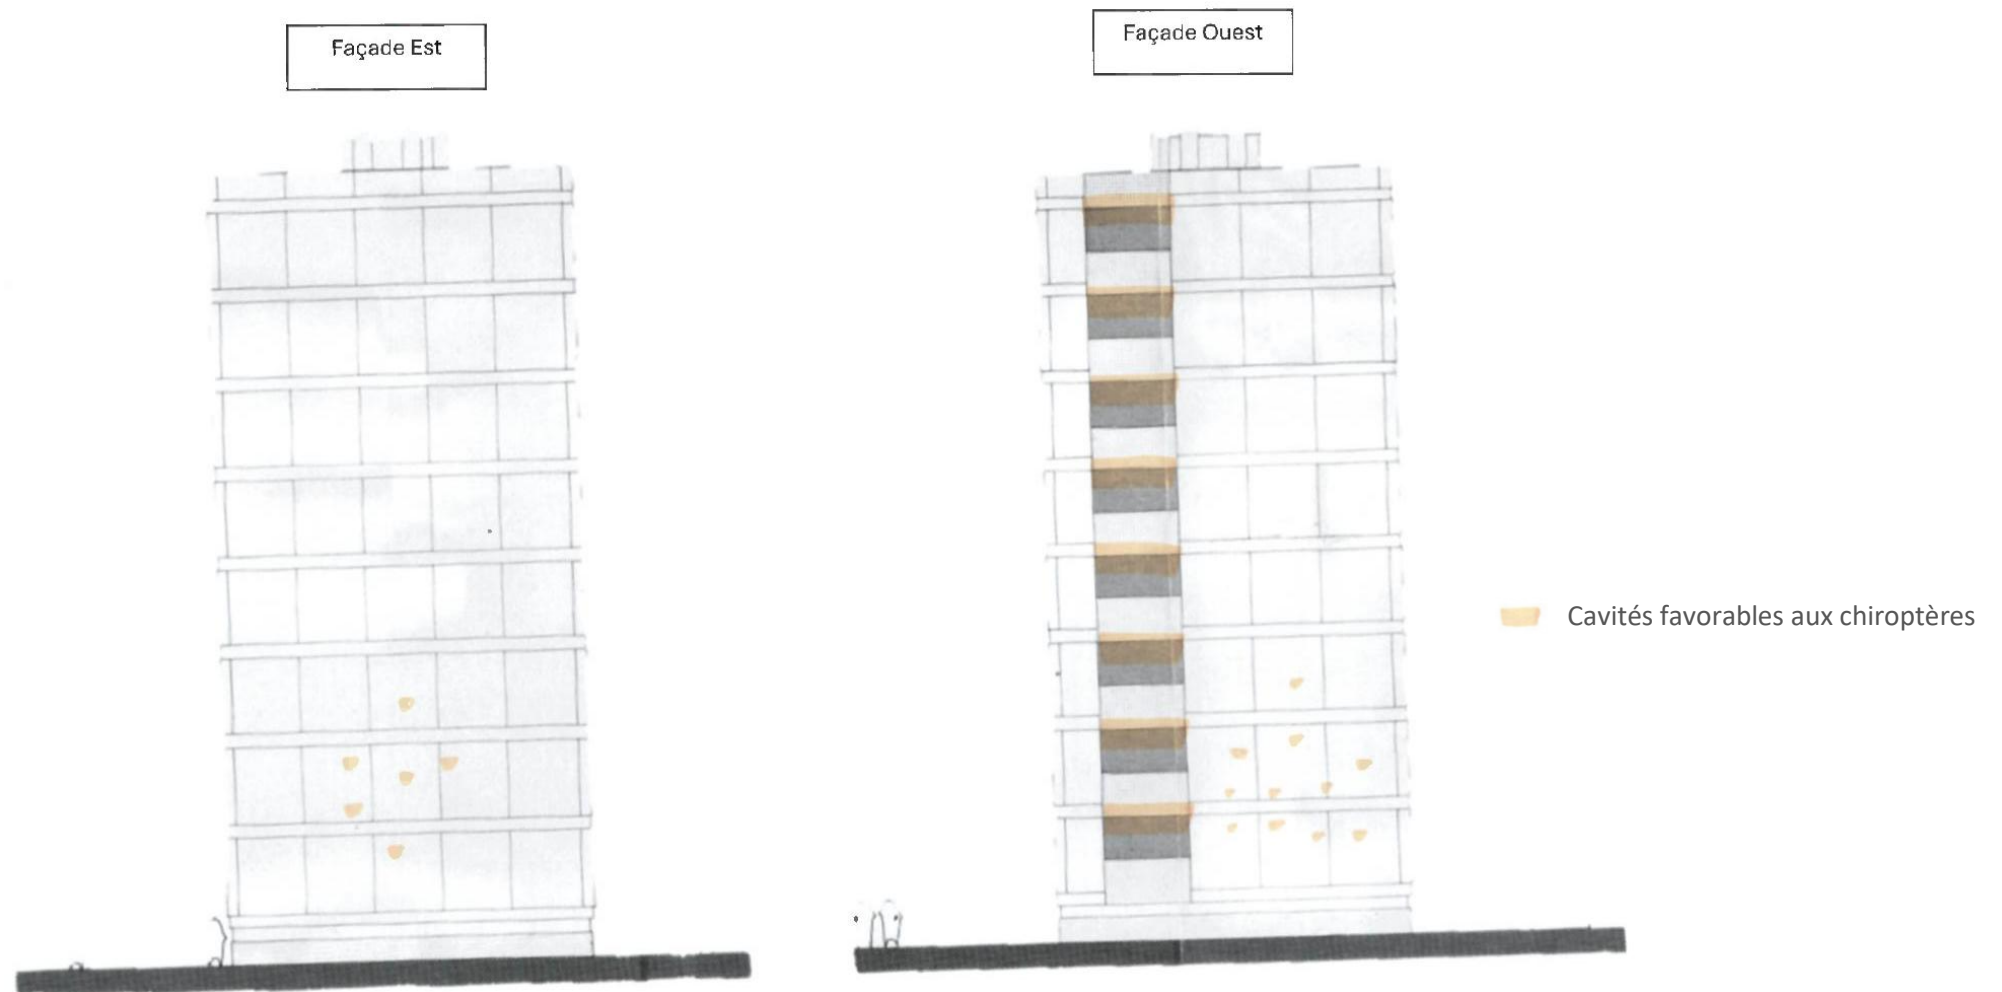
Plan du bâtiment 21 (façades est et ouest) des cavités favorables aux chiroptères
